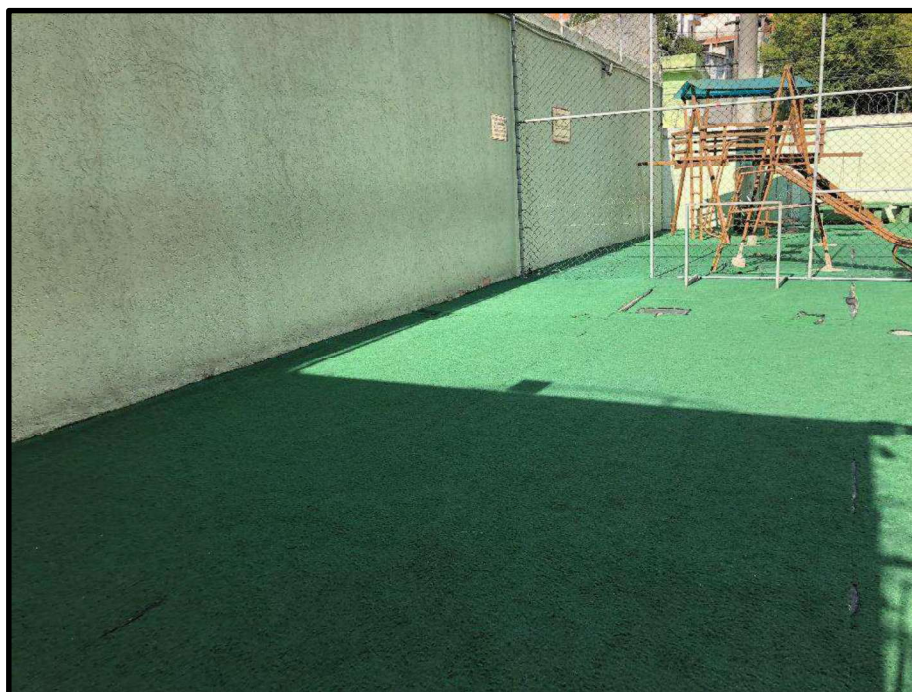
Quadra Poliesportiva – Conjunto Residencial Athenas II
